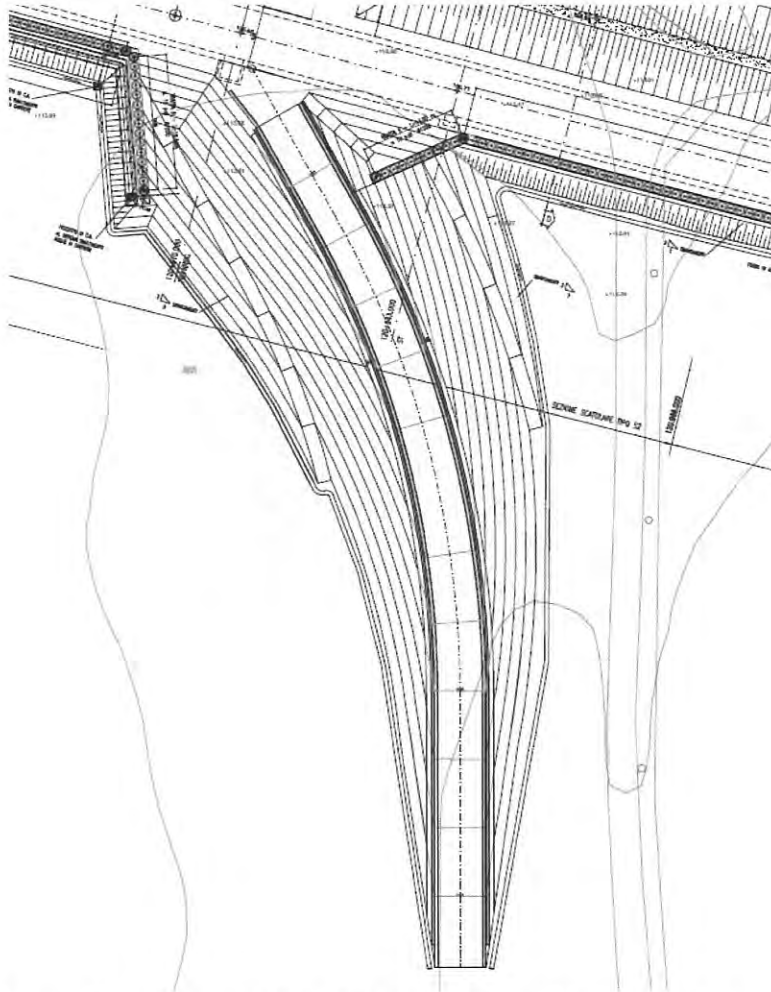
Planimetria della rampa di accesso e sezione tipologica muri ad U
